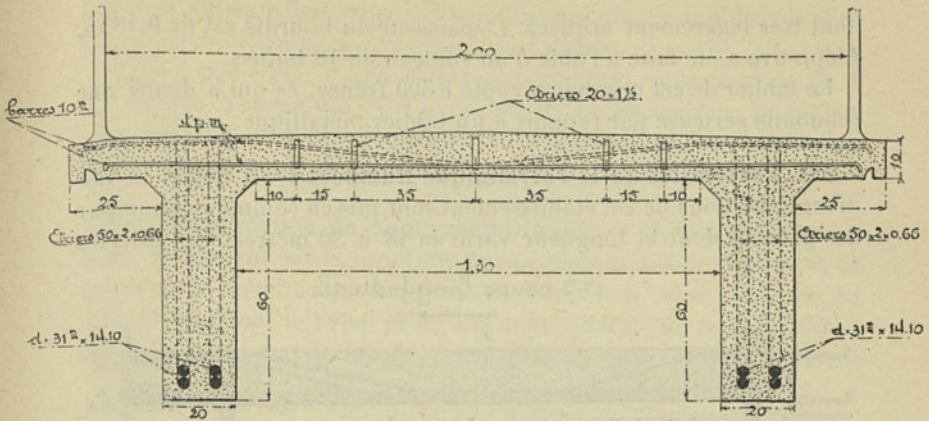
Passerelle à Yverdon sur le canal oriental (1896). Coupe transversale.
